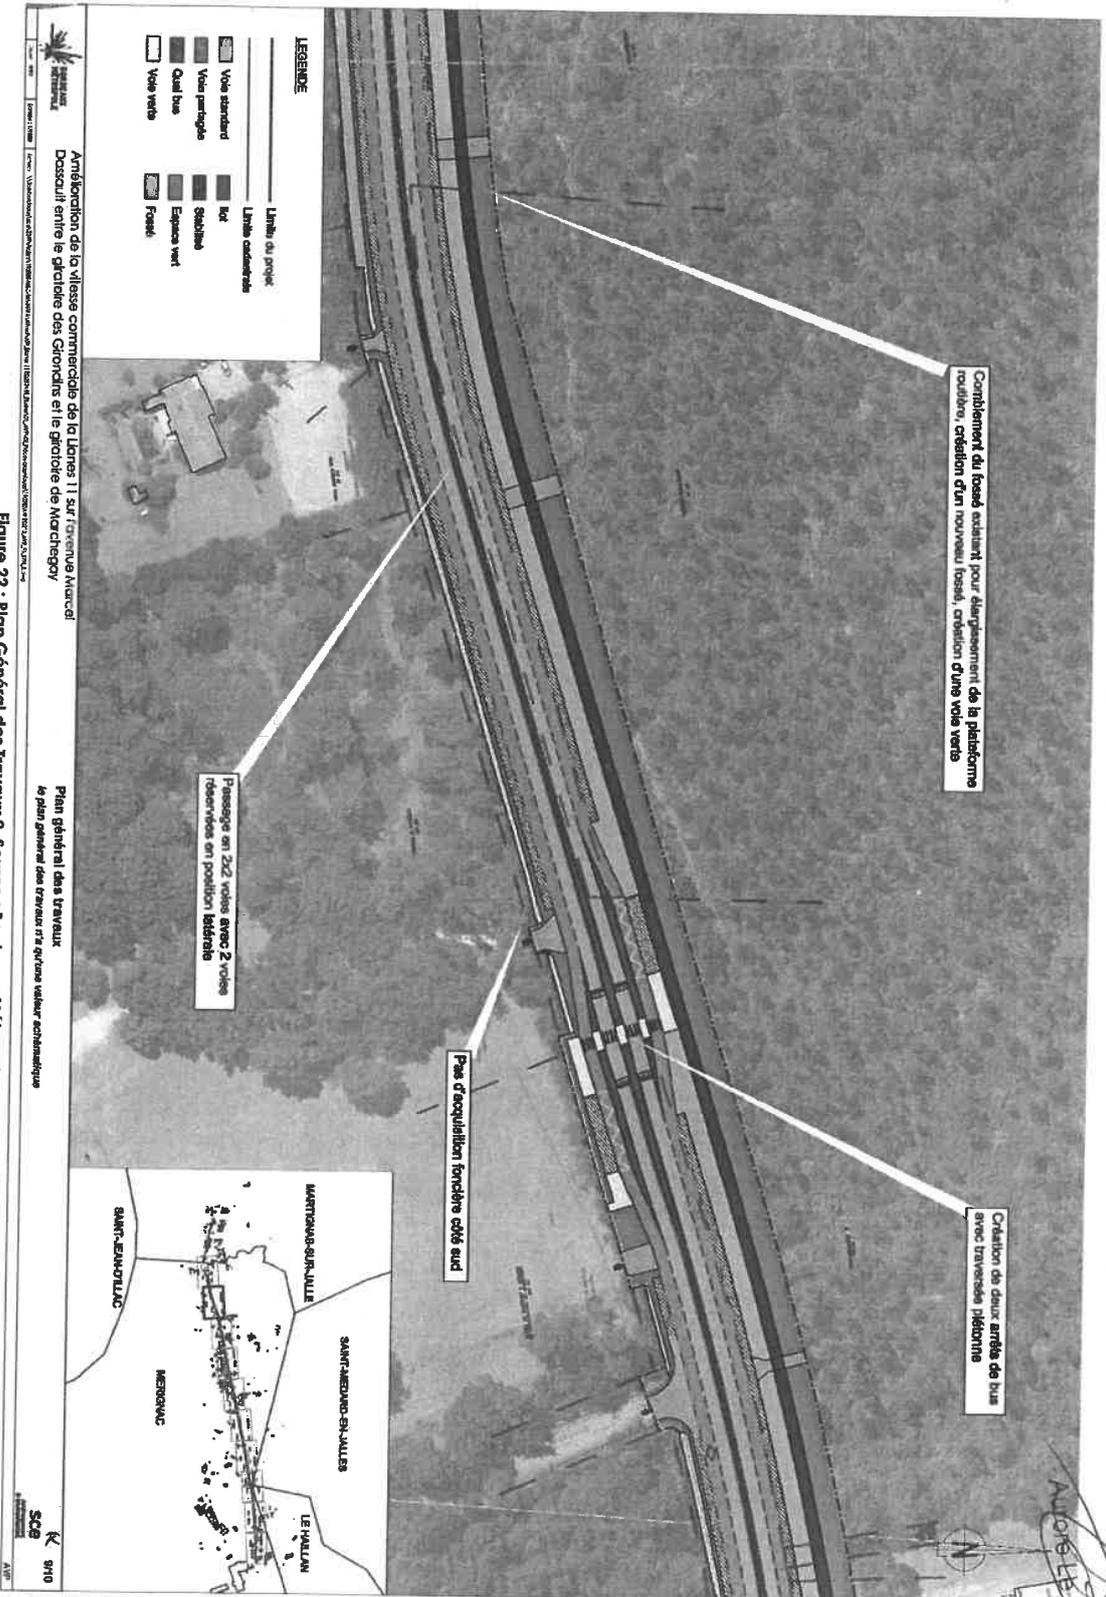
Plan Général des Travaux 2. Source : Bordeaux Métropole
